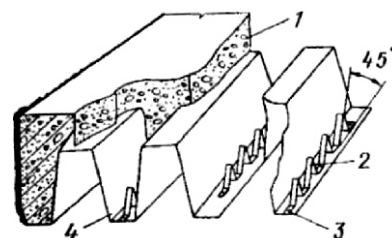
Розміщення гнутих пластинчастих анкерів у гофрах профільованої листової арматури монолітного залізобетонного перекриття:
